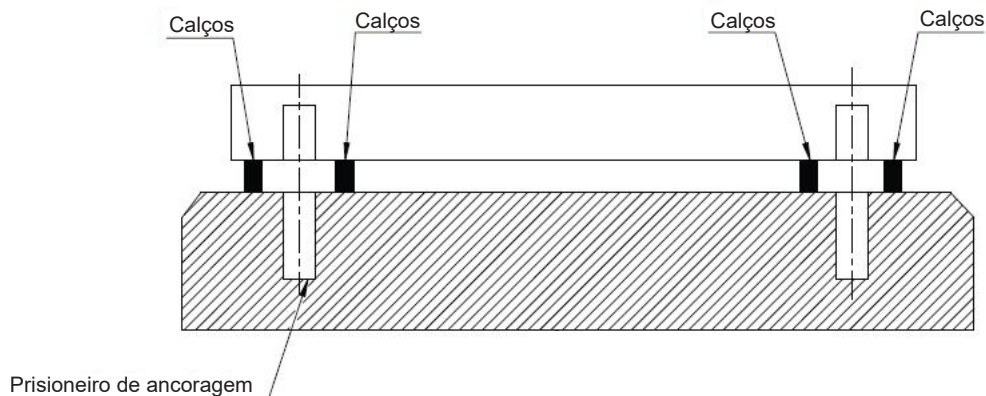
Aplicação de fundações de concreto, lâmina e ancoragem
